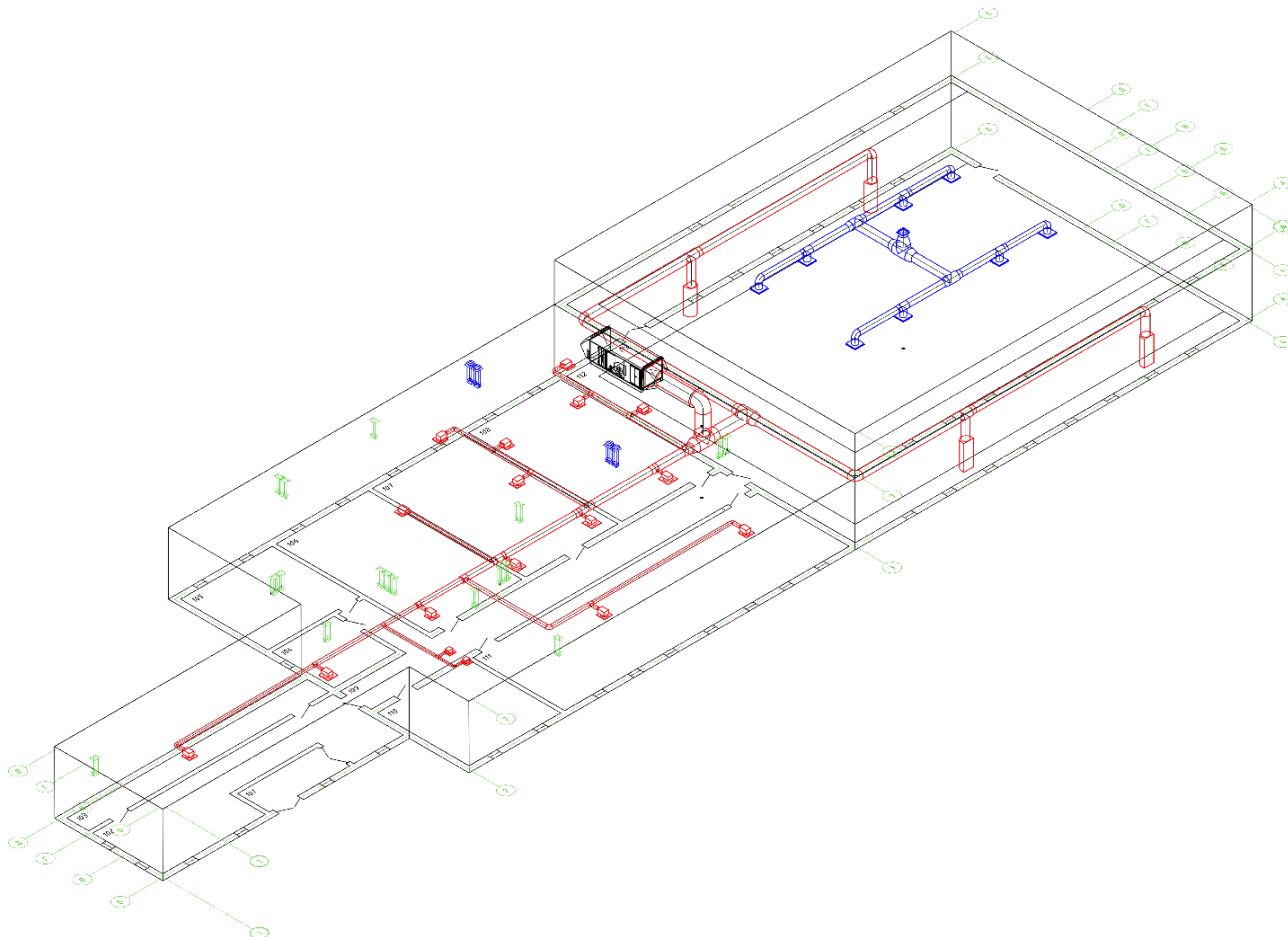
3D план системы вентиляции спорткомплекса.
